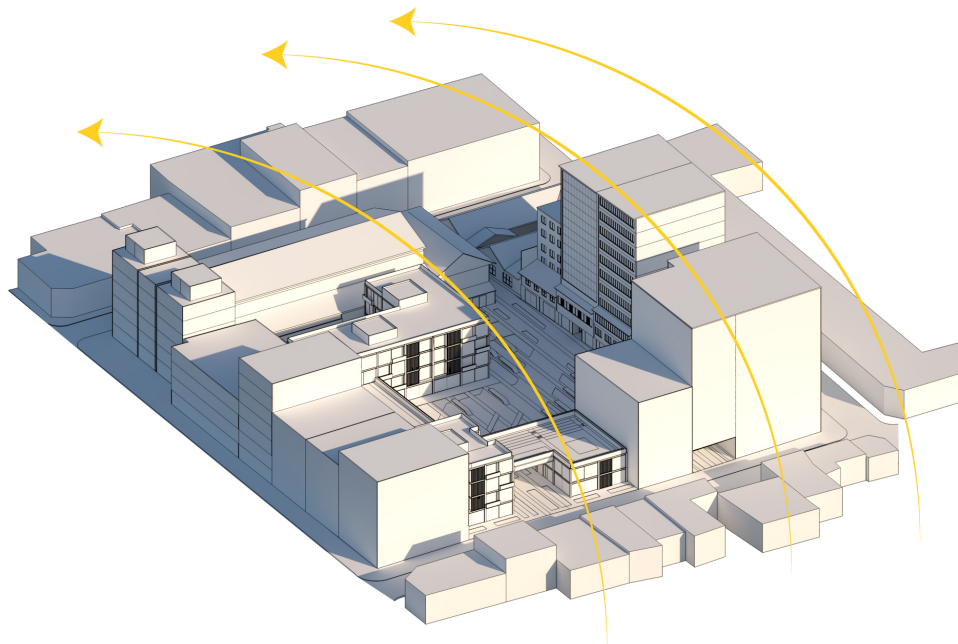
Recorrido solar sobre la propuesta. Fuente y elaboración: Autores
